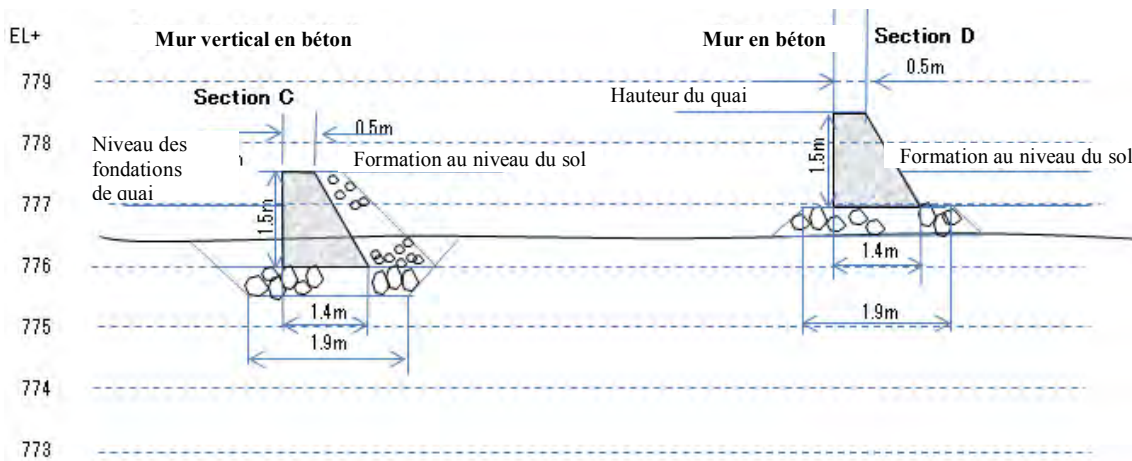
Mur vertical en béton, et mur en béton (2)
